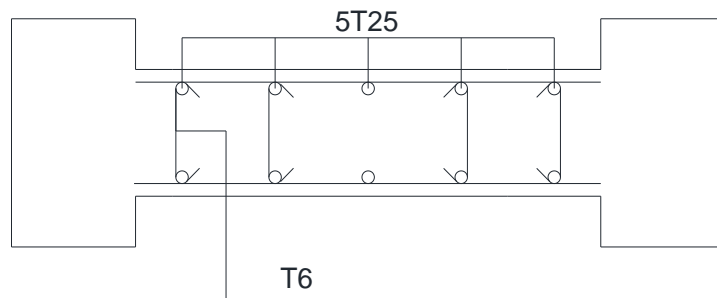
Schéma de ferrailage du voile (poutres noyées - plan régulier)
